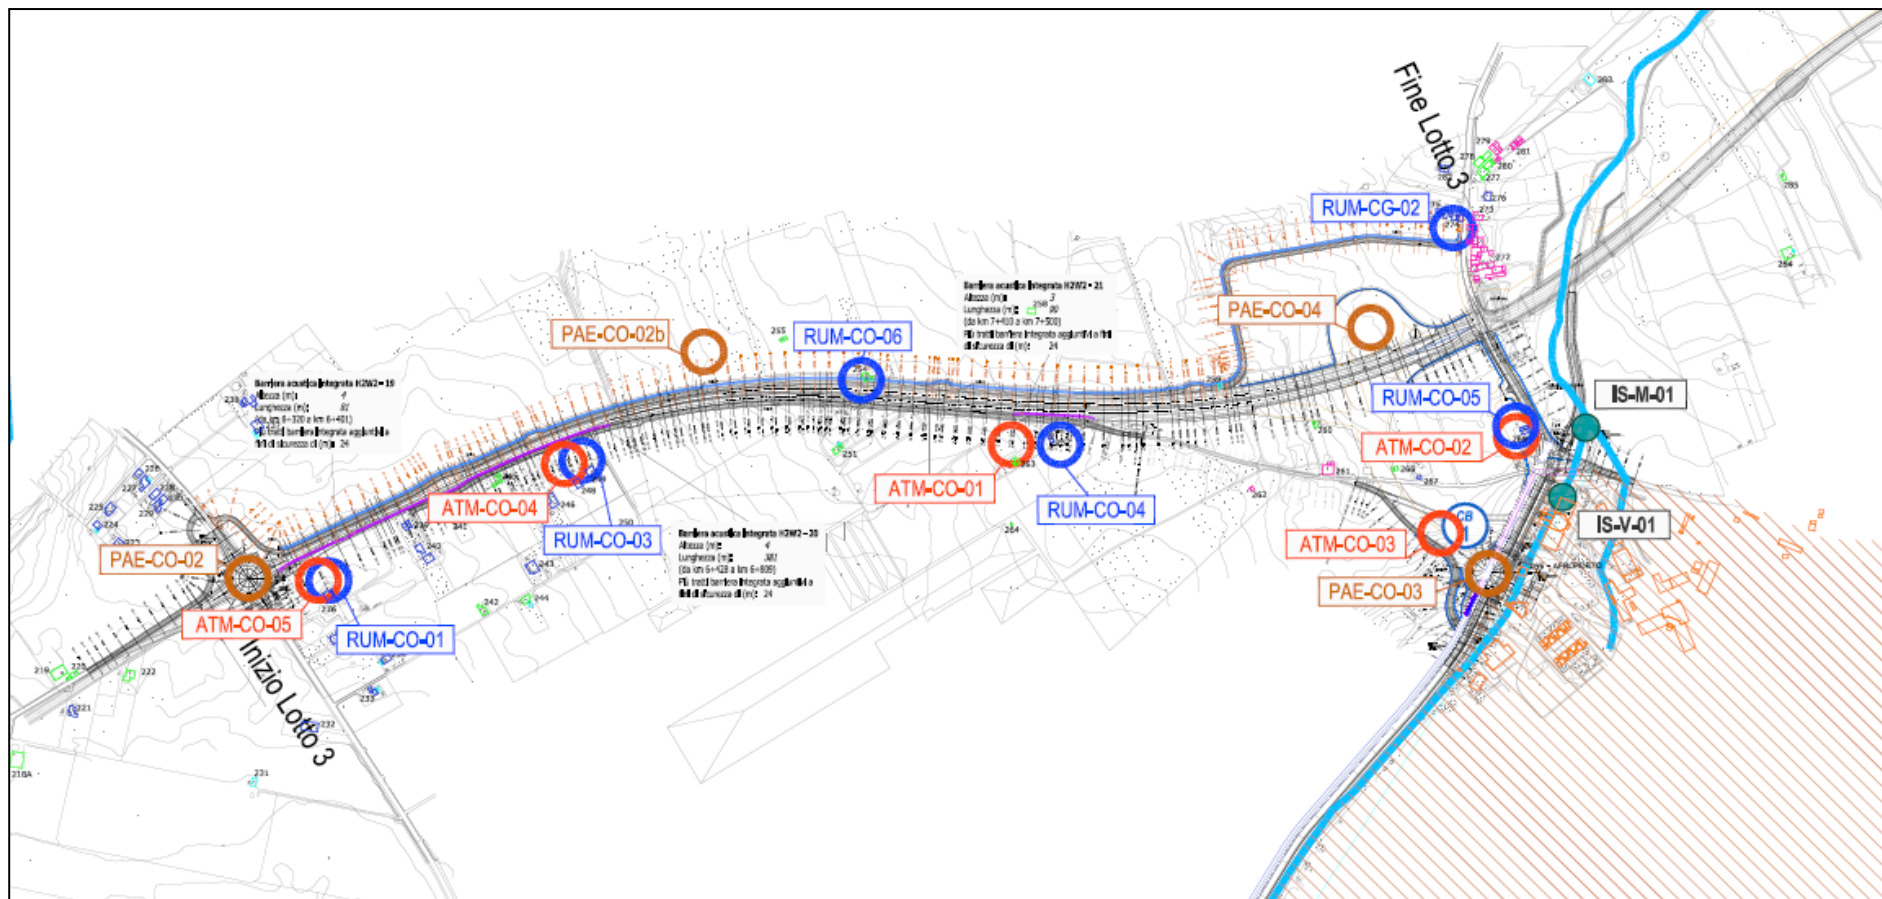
Stralcio planimetria PMA con individuazione dei punti di monitoraggio della componente paesaggio
